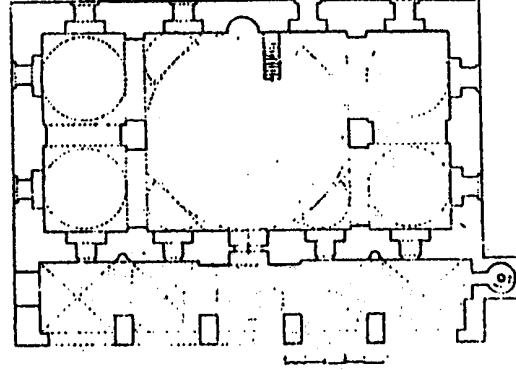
مسقط أفقي لجامع مصطفى بك في سيروز باليونان
